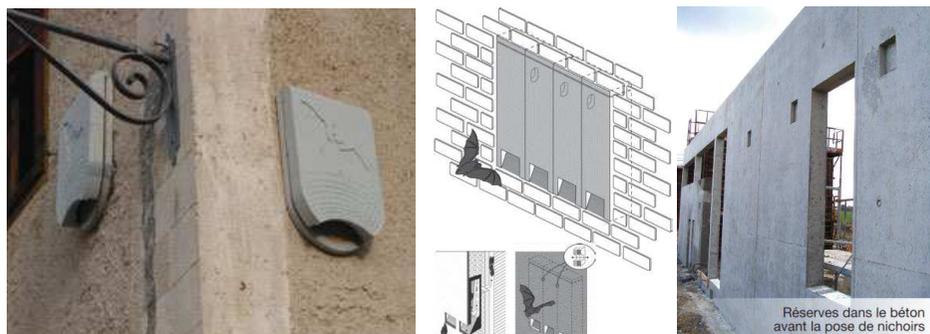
Nichoirs spécifiques aux chiroptères installés directement sur les façades (à gauche) ou encastrés dans les façades au moment de la conception du bâtiment (au centre et à droite). Sources : LPO.
